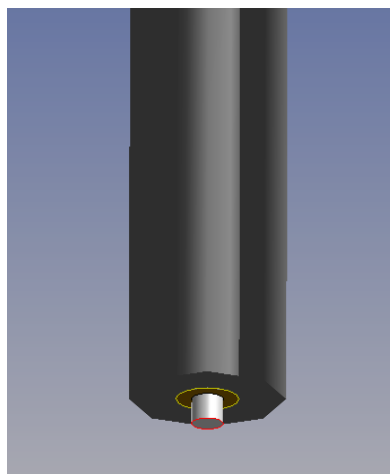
Pormenor da estrutura de suporte do pilar.
